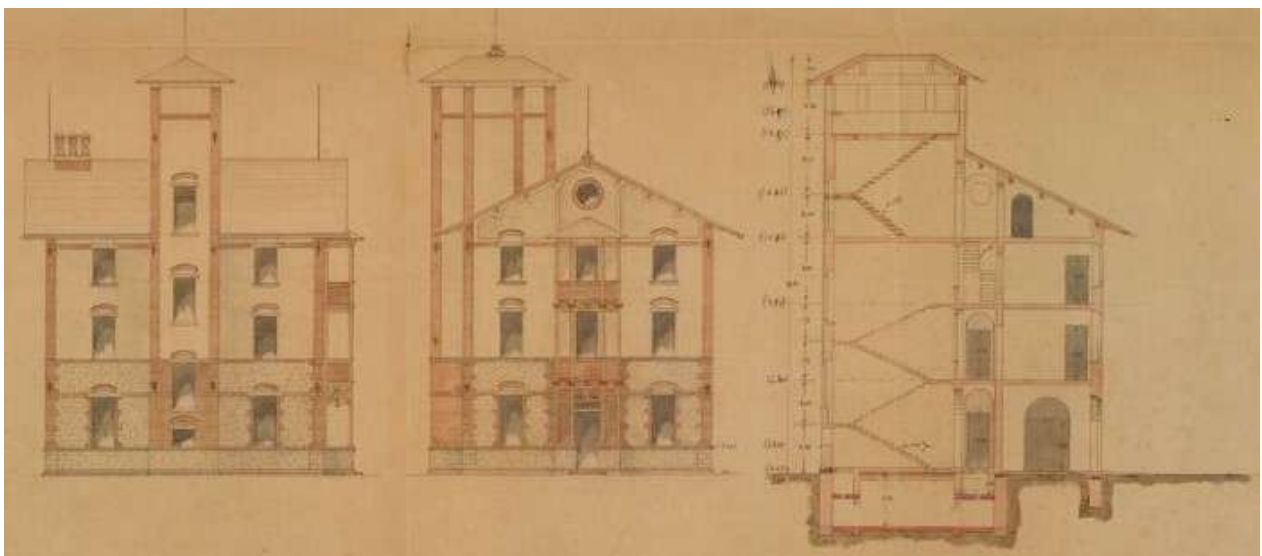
Nella tavola sono raffigurati: il 'Prospetto sul piazzale della stazione', il 'Prospetto sulla via comunale' e la 'sezione' del casello idraulico del canale Allacciante (CASTORE Regione Toscana)
